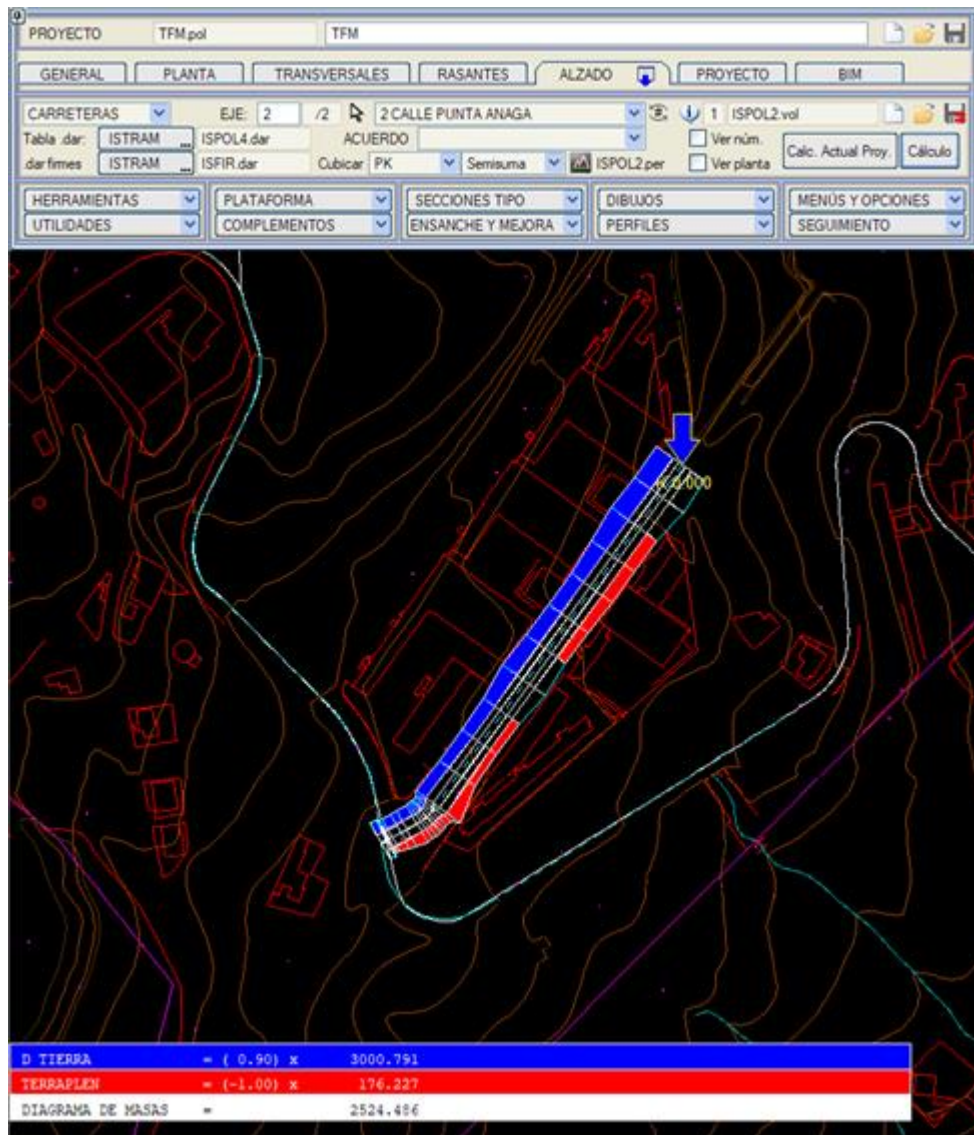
Menú Alzado y eje 2 calculado. Fuente: Elaboración propia.
